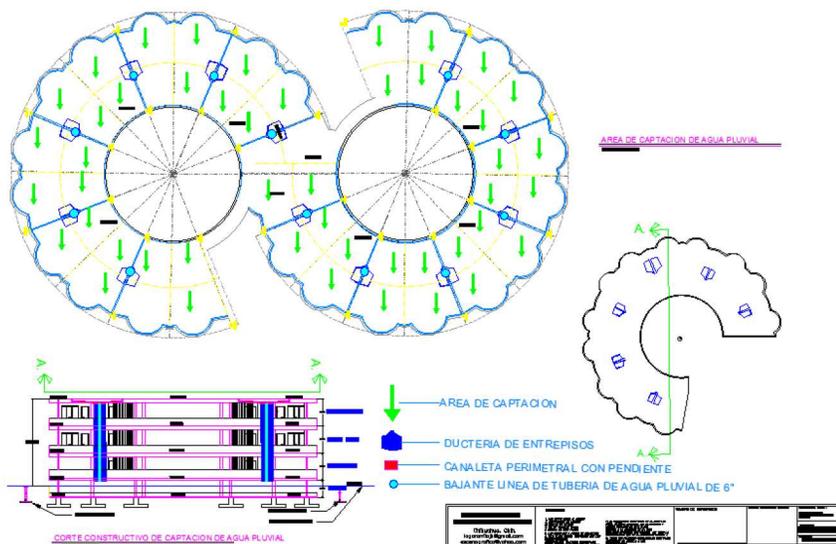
Plano de sistema de captación de agua pluvial (detalles)
